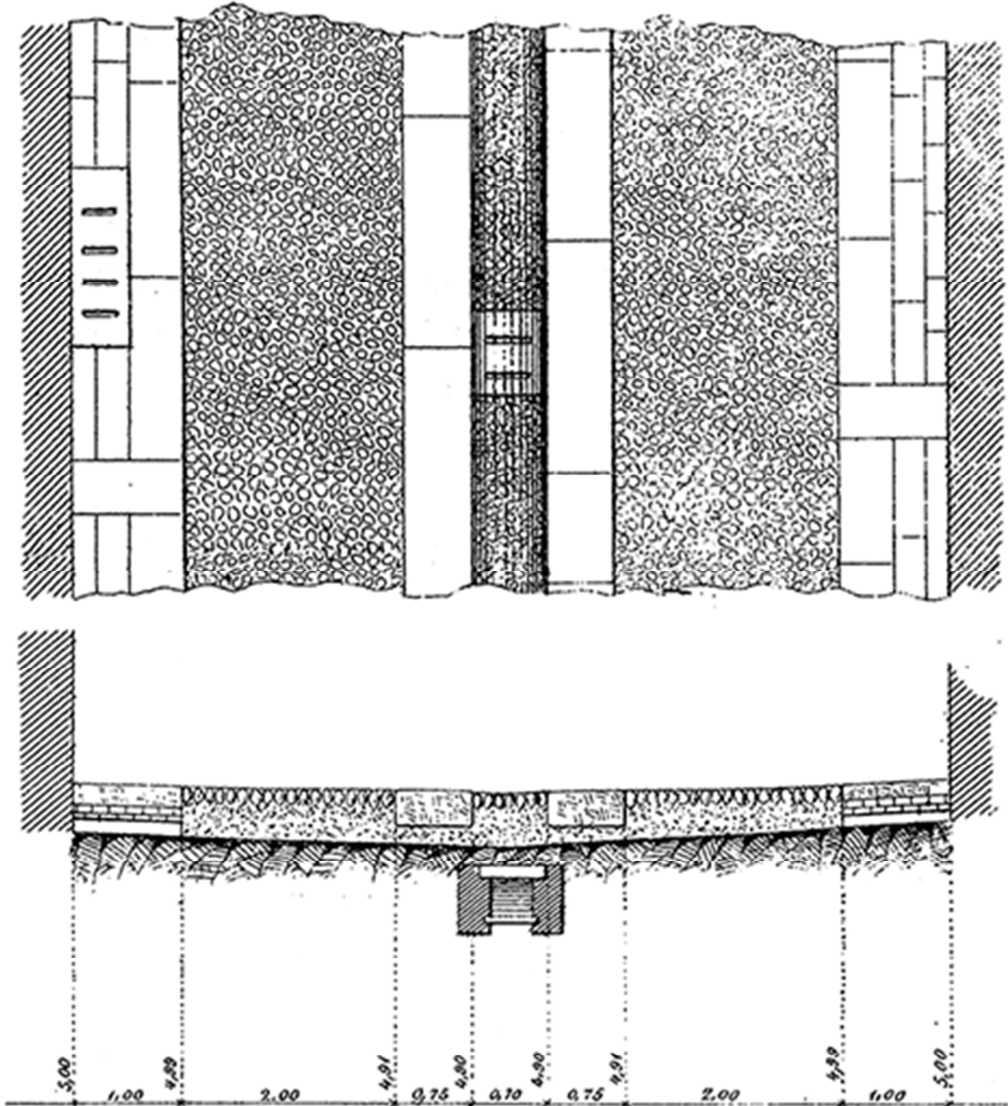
Pianta e sezione trasversale di un acciottolato misto [114].
